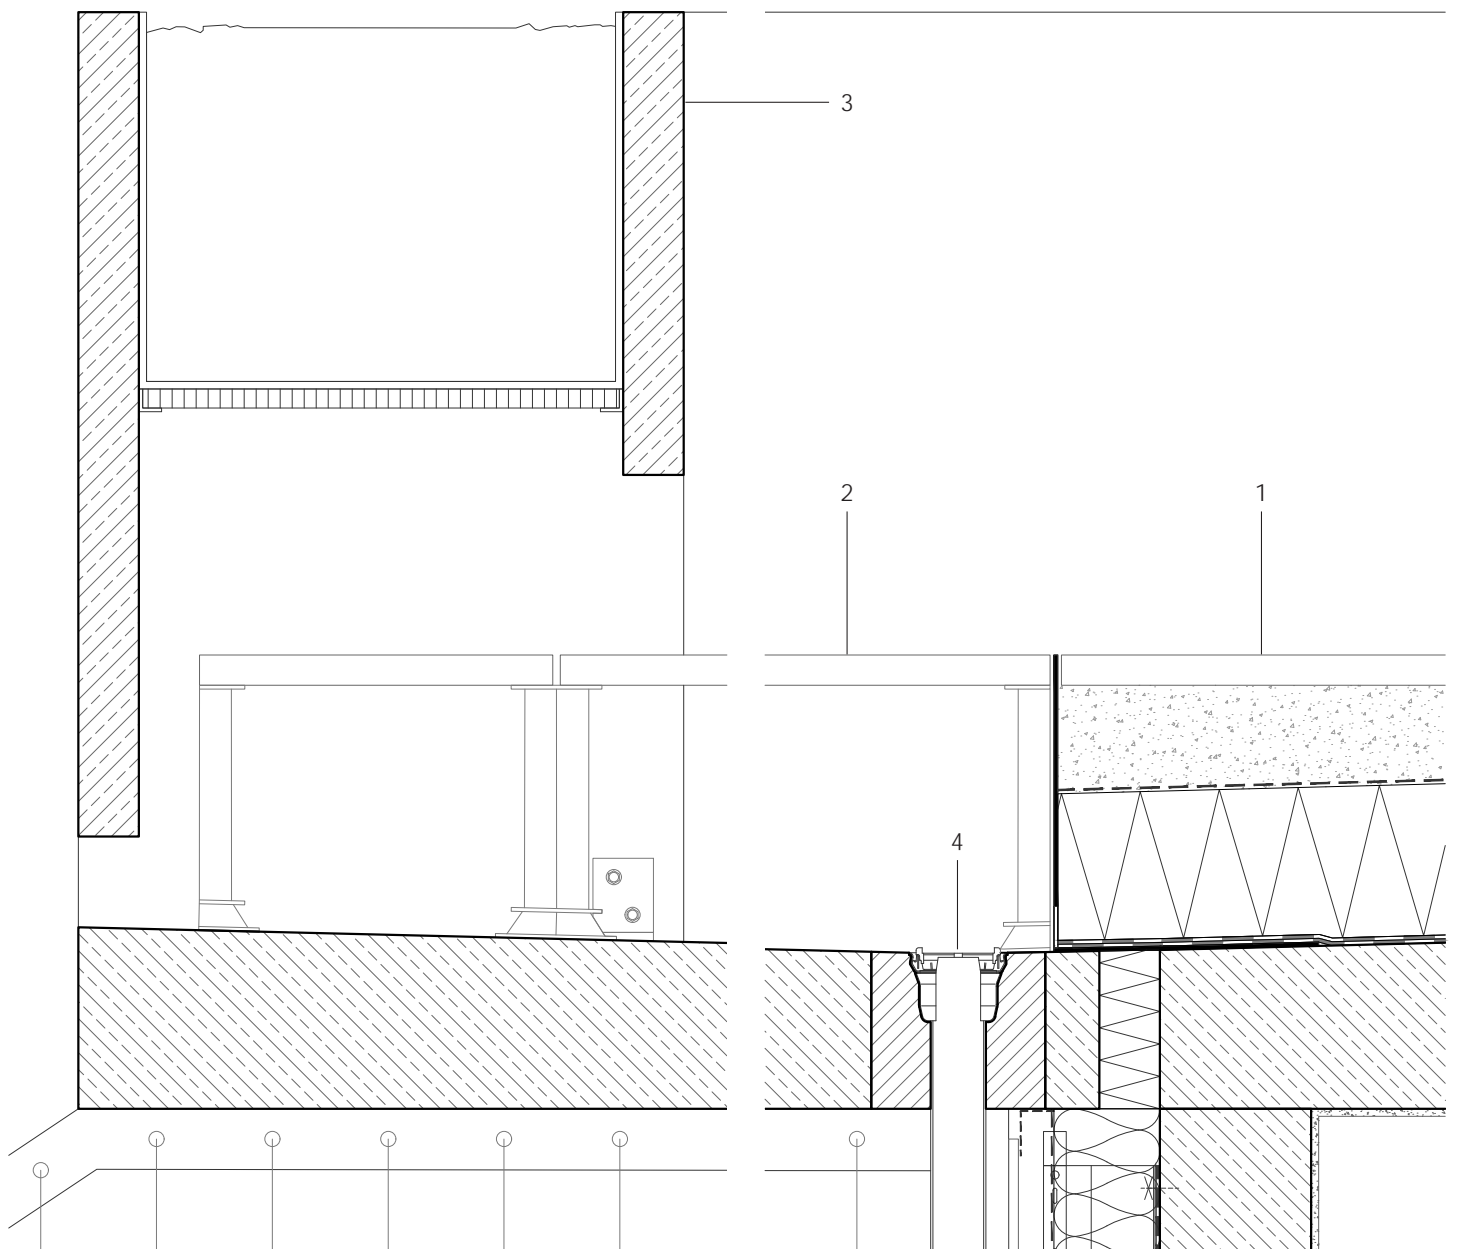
Detailschnitt Dachschwimmbad M 1:40.
